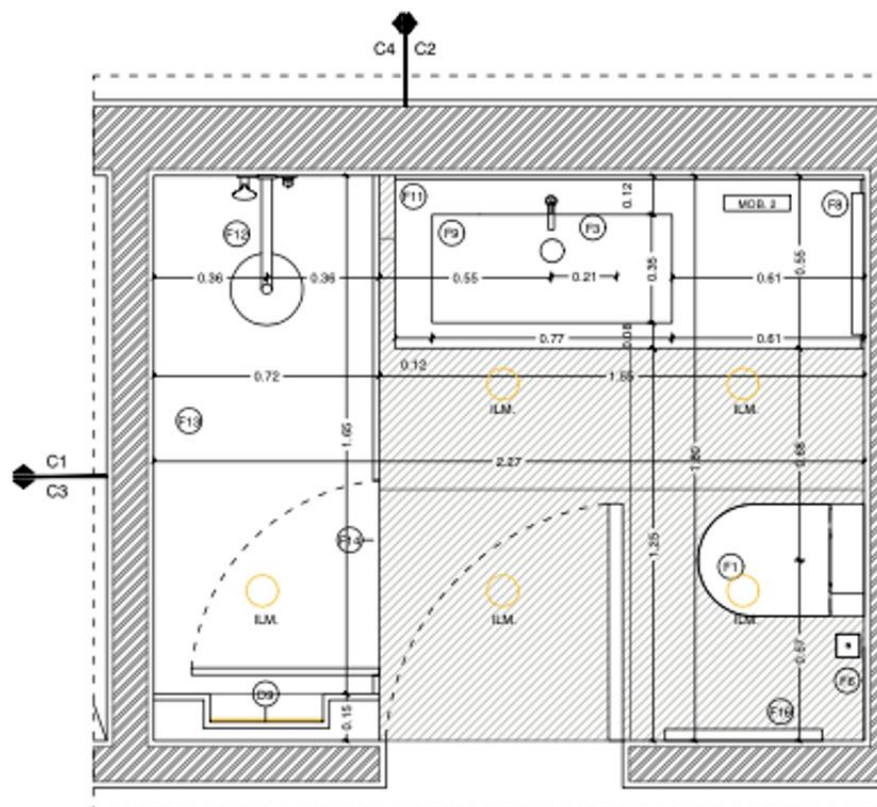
Planta da Instalação sanitária da Suite. Fonte: Catarina Batista *Studio
